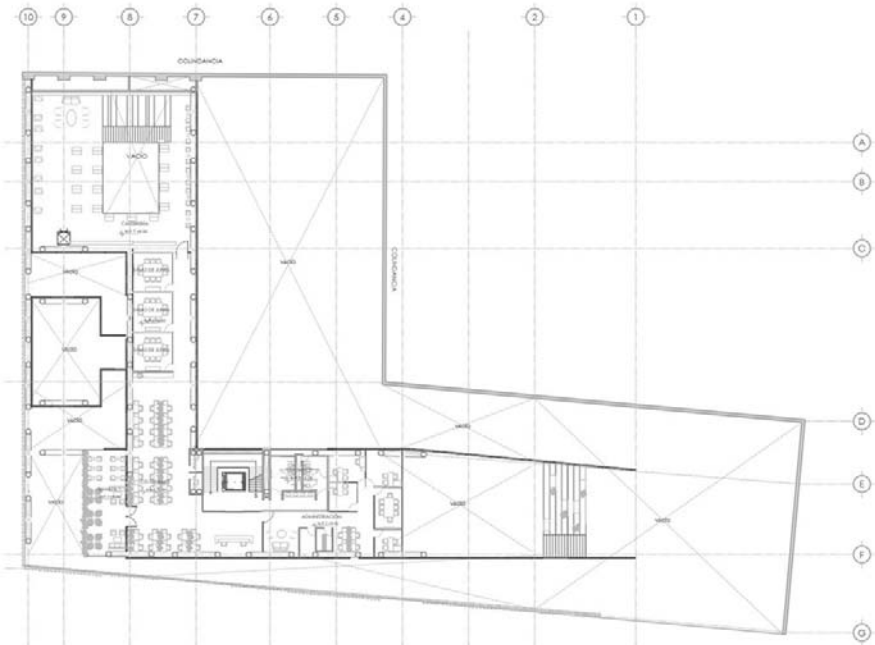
Plano de planta segundo nivel, [elaboración propia].
